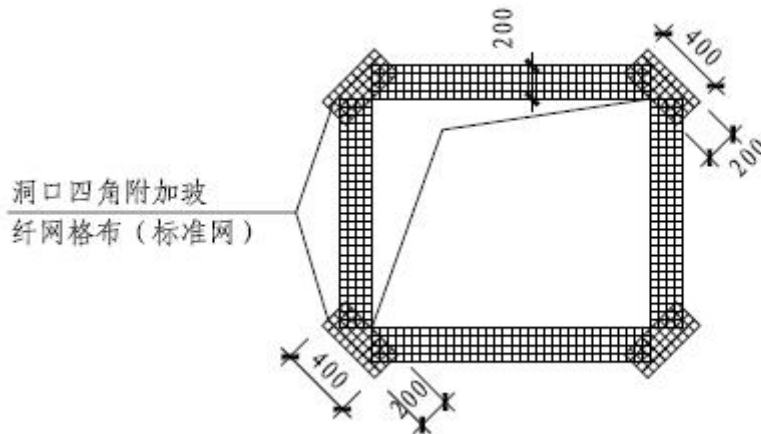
门窗洞口部位玻纤网布增强示意图
